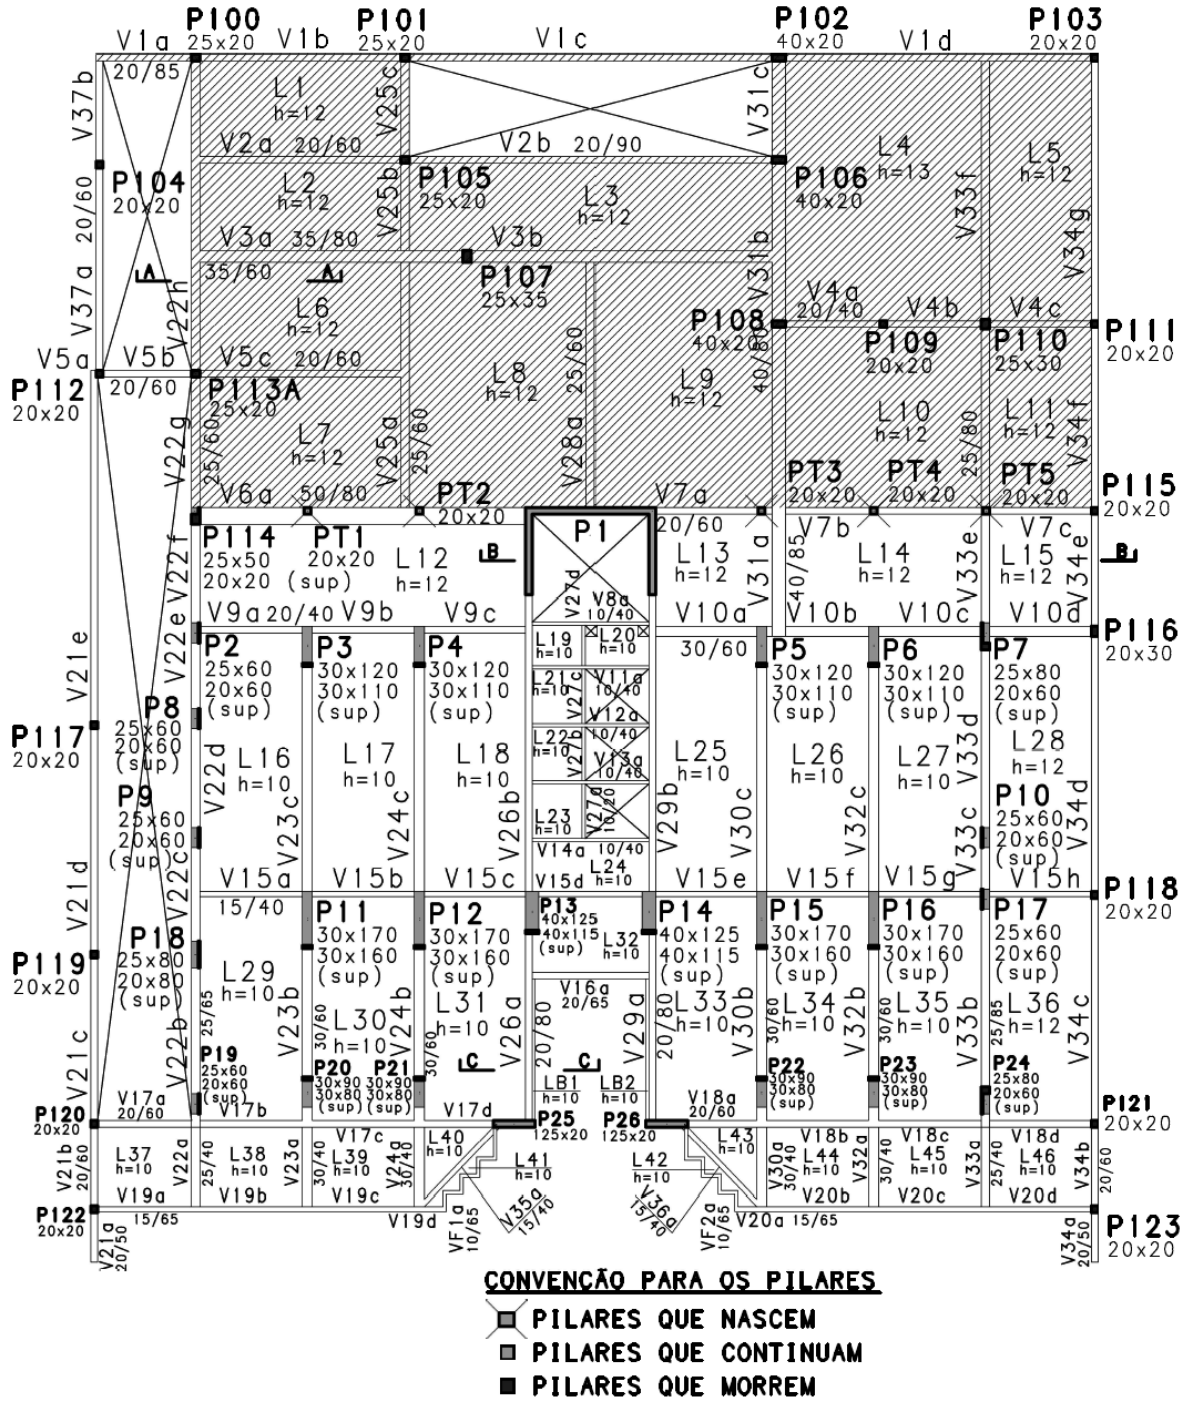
Planta da segunda laje, pilotis, el.+5,90.
